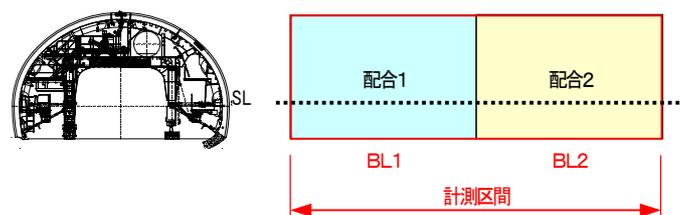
トンネル軸方向断面図（左）と側方向立面図（右）
